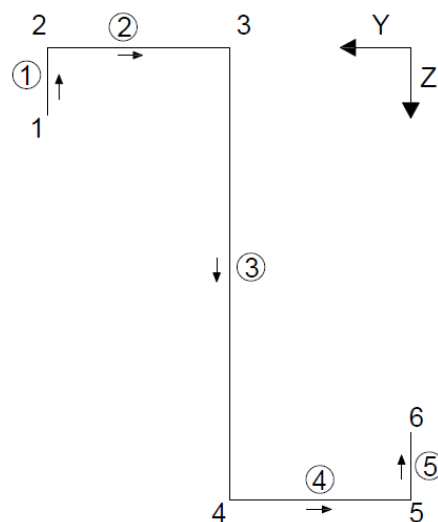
Perfil abierto de una sección delgada (Fuente: Javier Gilbert)
